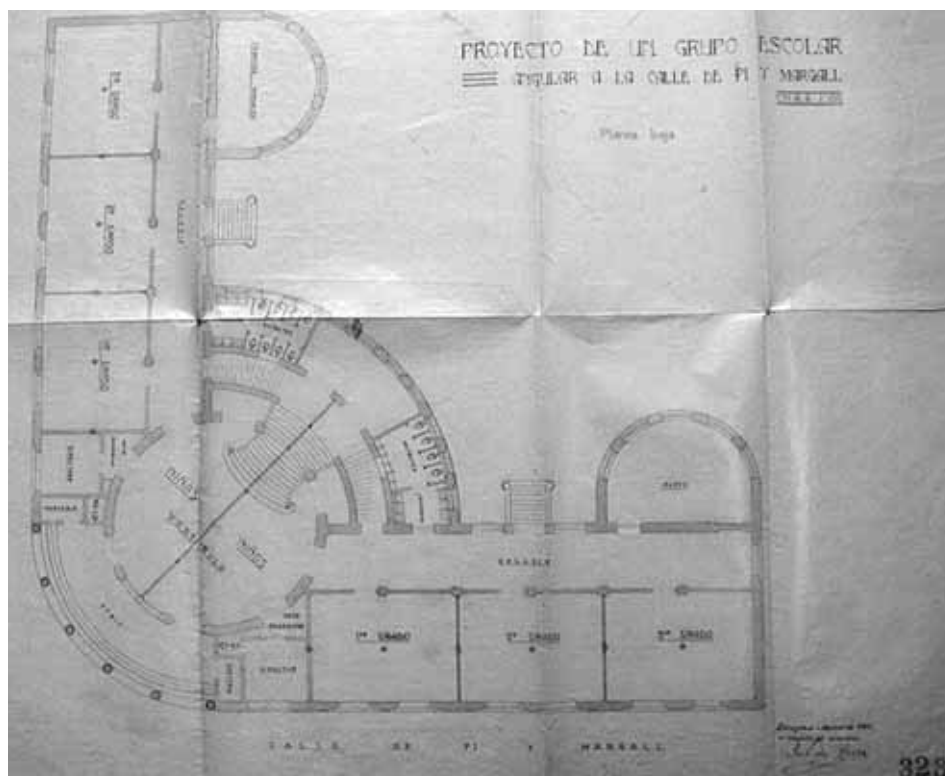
Proyecto: planta baja del grupo escolar «Gascón y Marín».
